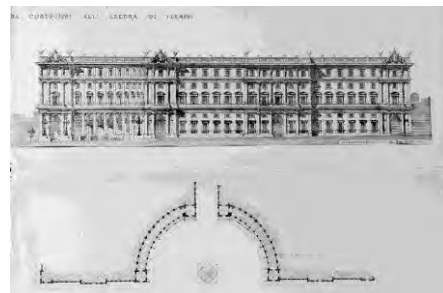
palazzi su piazza Esedra prospetti di destra e pianta dei portici
